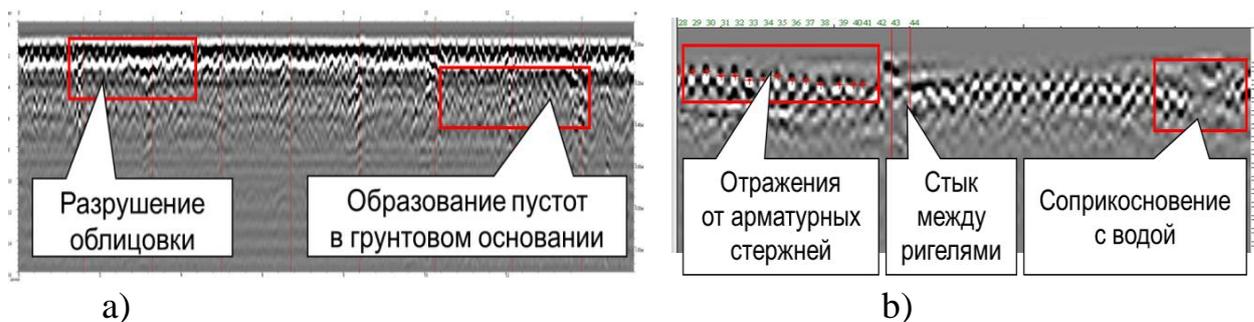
Фрагменты радарограмм: а) Разрушение бетонного покрытия с образованием пустот в грунтовом основании; б) Смещение арматурных стержней и просадка грунтового основания
